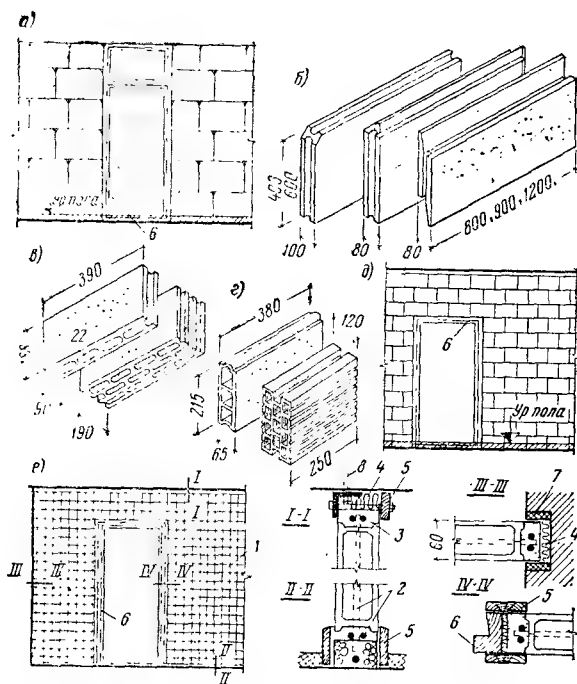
Мелкосборные и стекложелезобетонные перегородки
